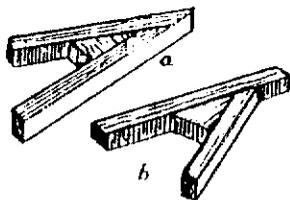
Cale d'encoignure a) mauvais, b) bon.
